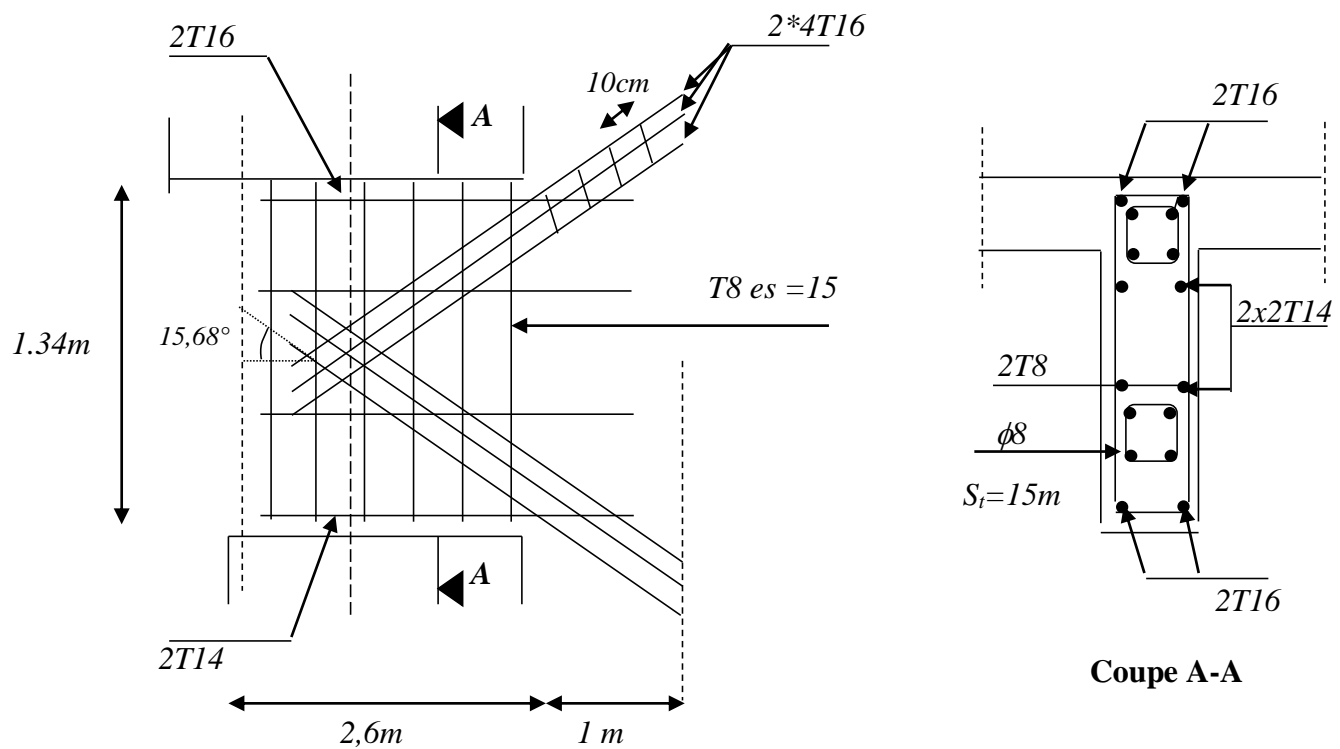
Ferrailage des linteaux. (RDC a 4 émé)
